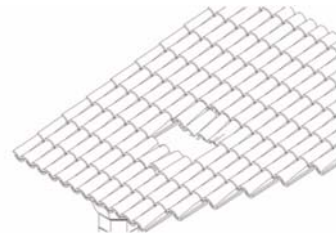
Schadenstyp P16: Schäden an der Dachhaut
